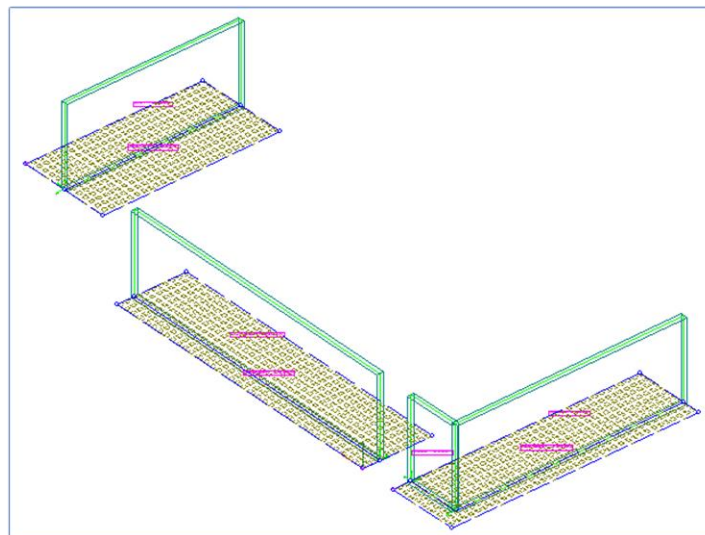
Ejemplo de modelos para el cálculo estructural de muros
